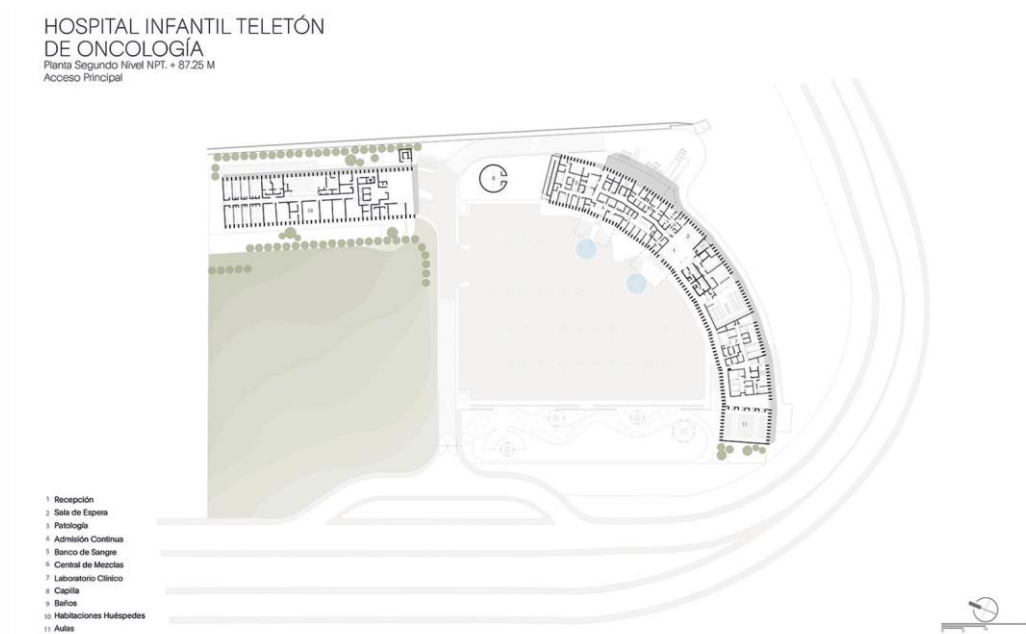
Planta arquitectónica *Del Hospital Infantil Teletón De Oncología 2do nivel
